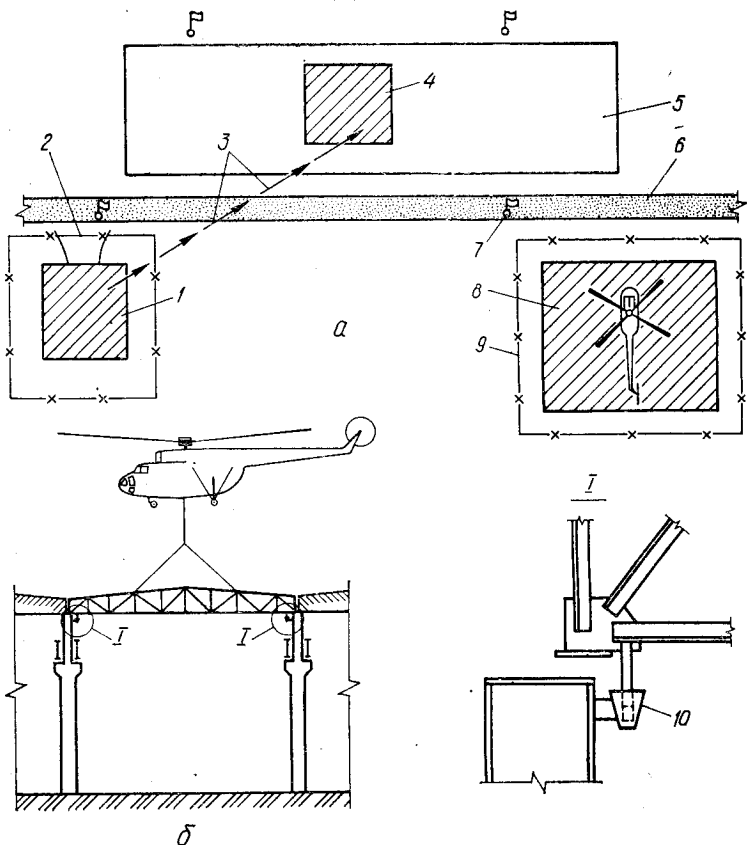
Схема использования вертолета для монтажа конструкций: а — схема организации монтажной площадки; б — схема монтажа стропильной фермы; 1 — площадка укрупнительной сборки; 2 — шлаглаум; 3 — направление перемещения вертолета с конструкциями; 4 — зона монтажа конструкций; 5 — реконструируемый цех; 6 — атодорога; 7 — сигнальщик; 8 — площадка для вертолета; 9 — проволочное ограждение; 10 — улавливающая воронка
